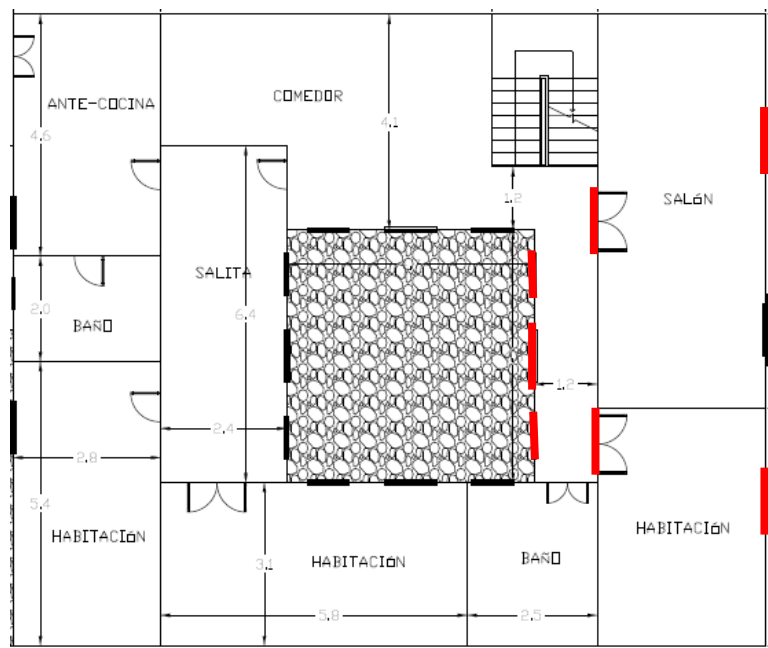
Puertas y ventanas abiertas zona oeste segunda planta
